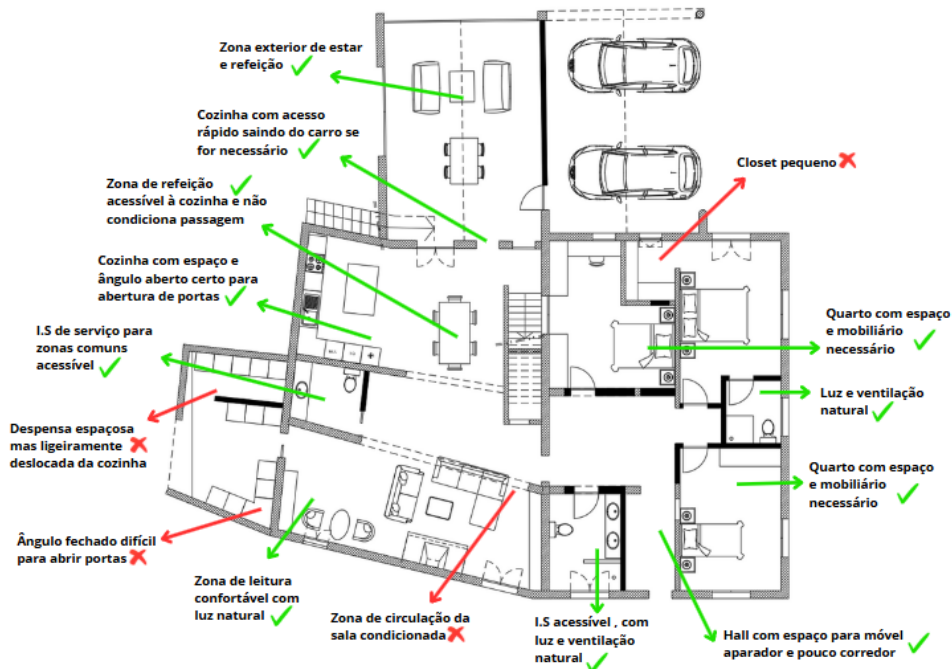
Análise de plantas esboço, proposta 9 , piso 0
